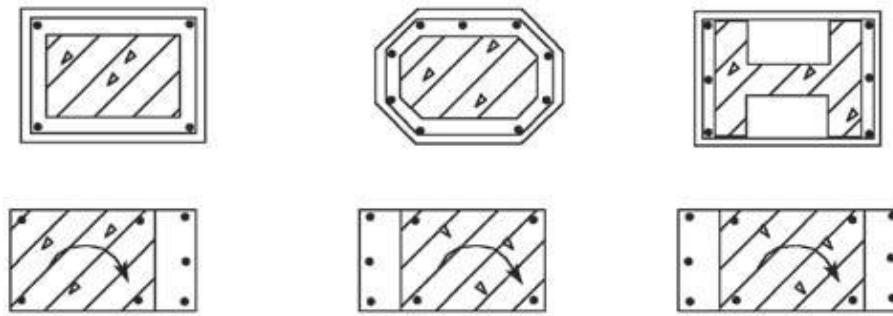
Reforzamiento de columnas mediante el incremento de la sección transversal. Fuente: *Retrofitting Design of Building Structures*, Xilin Lu (2010).
